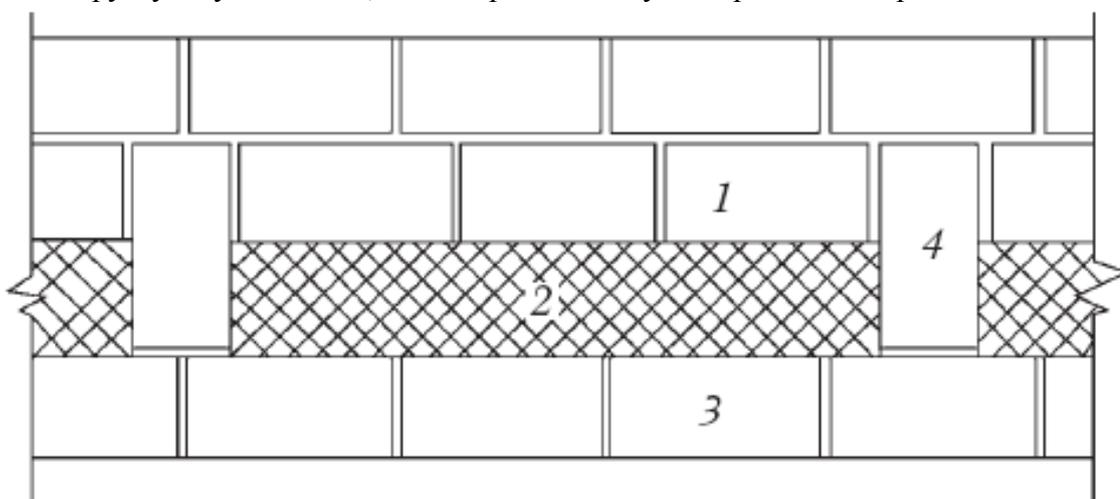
Колодцевая кладка: 1 – наружная верста; 2 – утеплитель; 3 – внутренняя верста; 4 – поперечные кирпичи
